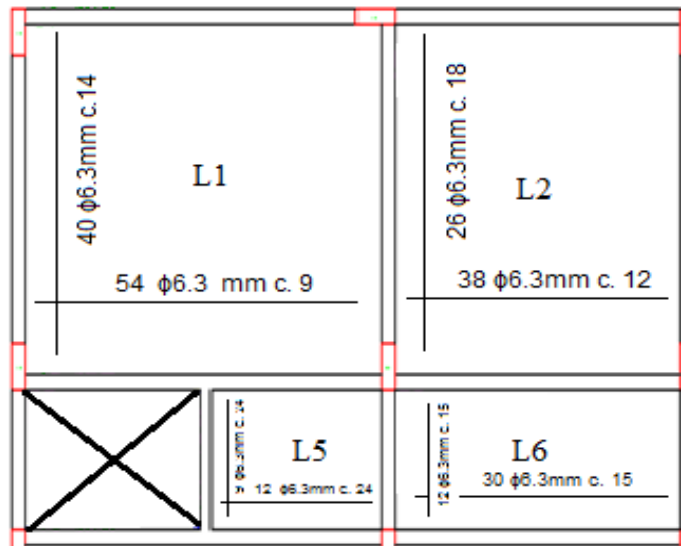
armadura de tração para as lajes L1, L2, L5 e L6
